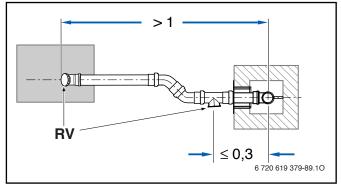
Esempio di disposizione delle aperture di ispezione per un condotto fumi orizzontale con deviazione in locale di posa – vista dall'alto (quote in m)
